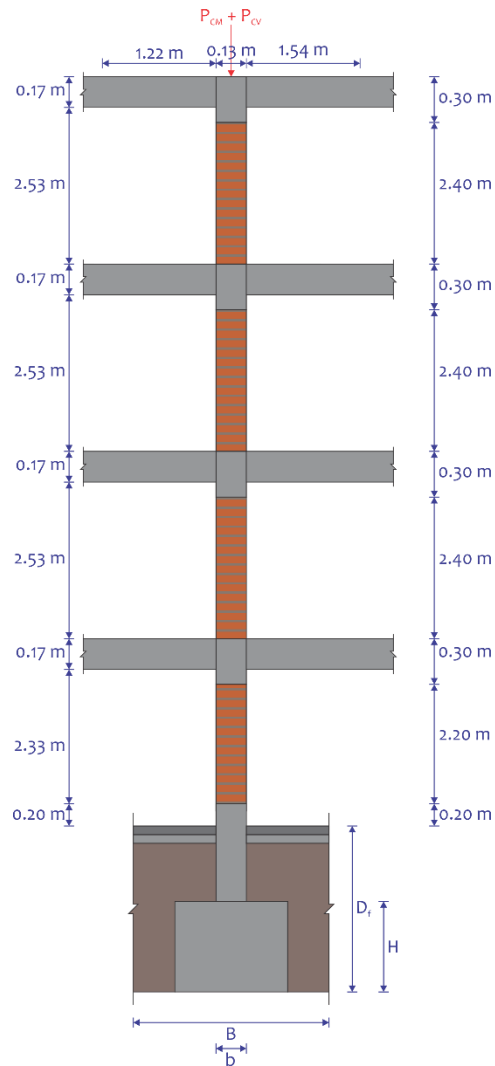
Corte en Elevación del Muro 13 en Dirección “y”.
